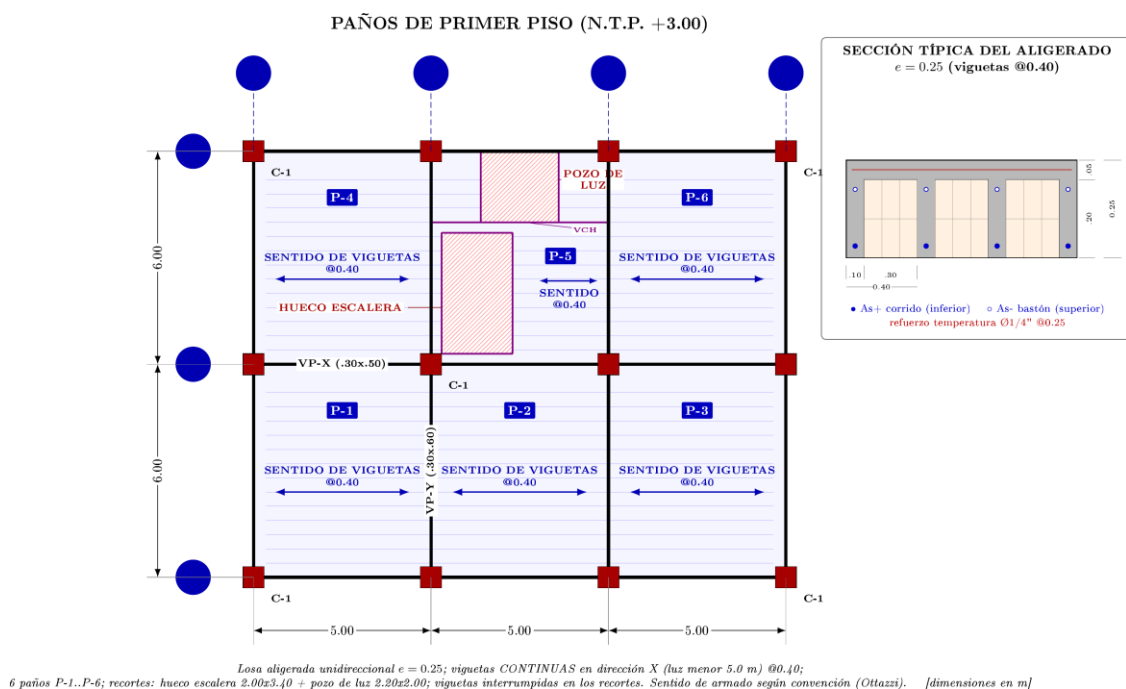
Distribución de paños de losa aligerada, primer piso.
